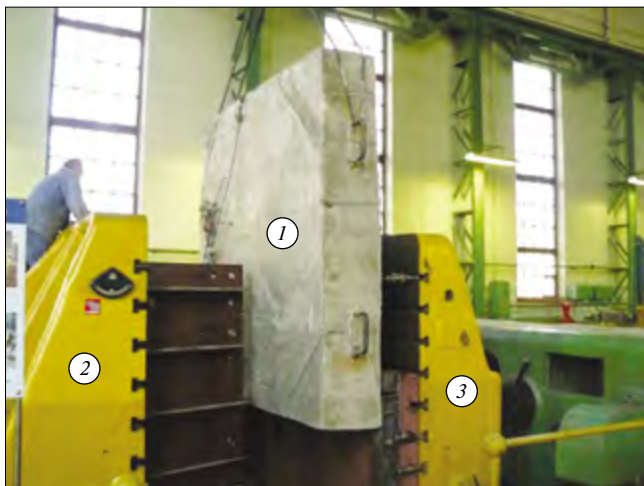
Опытный образец в стенде для испытаний: 1 – ж/б плита; 2 – плита прессы; 3 – опорный контур
